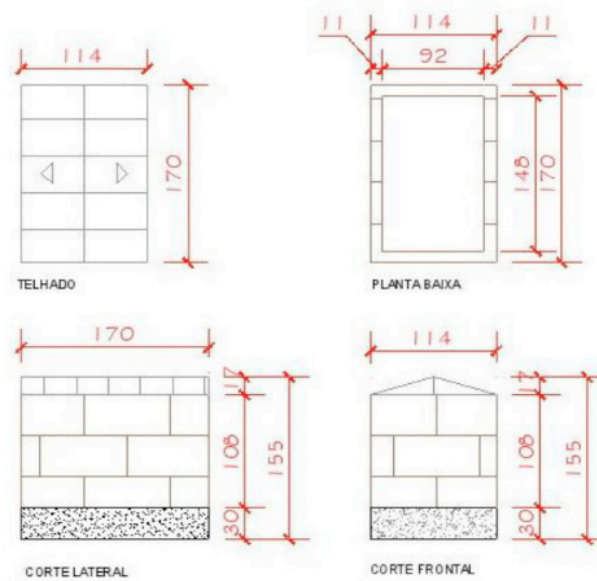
Projeto arquitetônico do modelo de referência M2 – Planta baixa e fachada (Própria, 2016).
